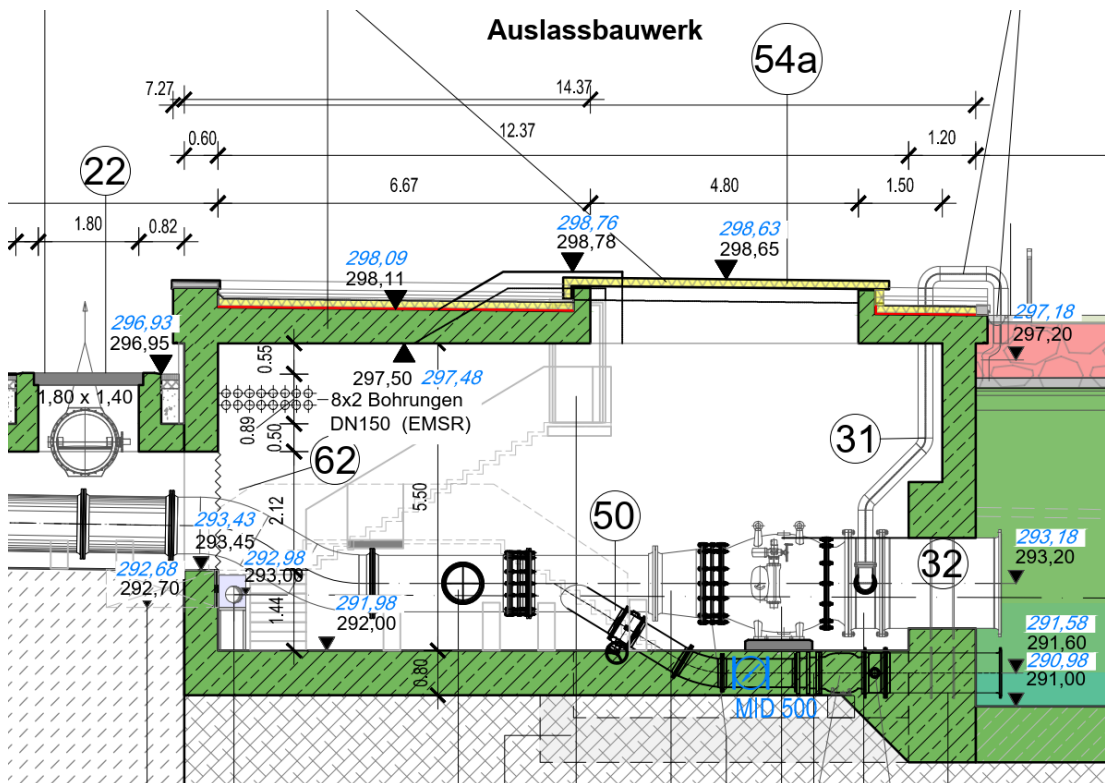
Deckenöffnung zur Demontage-/Montage der Armaturen im Auslassbauwerk
